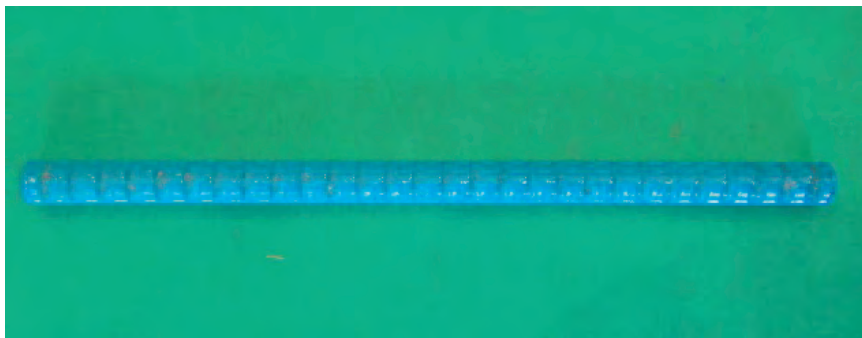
施工時損傷模擬後の鉄筋（条件11）
